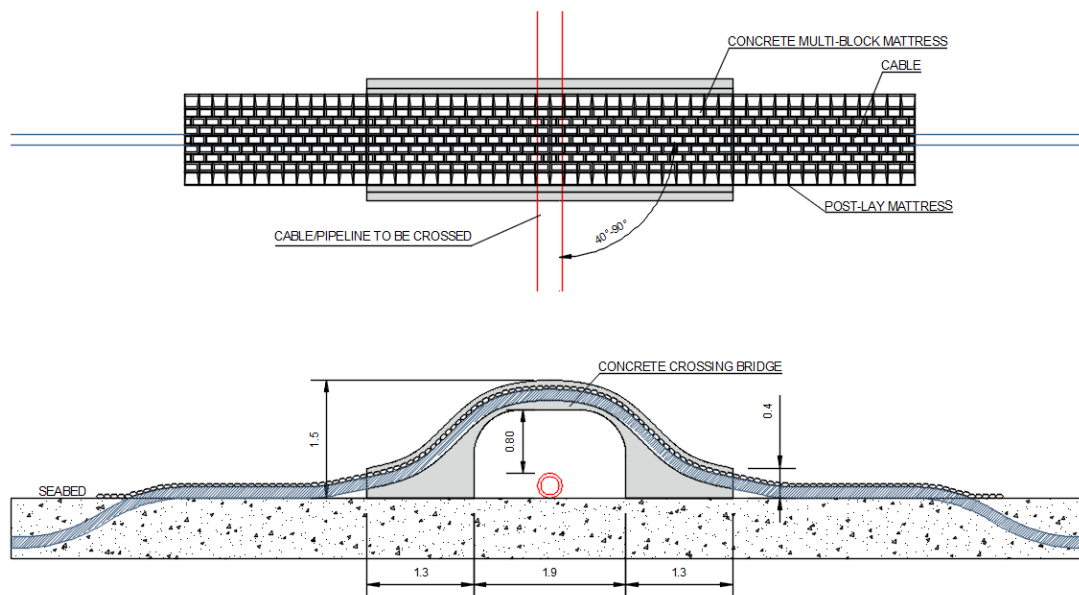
Scavalcamento di una condotta affiorante con Concrete Bridge ricoperto di Concrete Mattress
